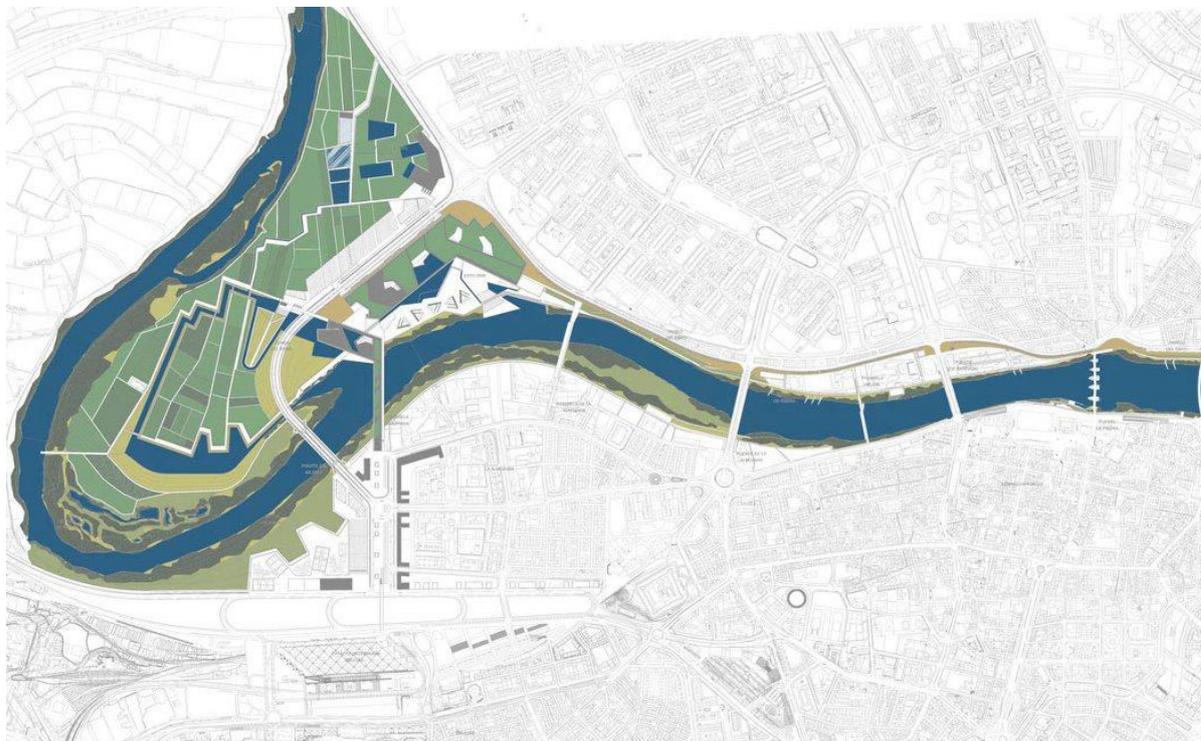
Planimetria generale di progetto del Parco delle Acque, Saragozza. © Alday Jovier, Christine Dalnoky, 2008.
